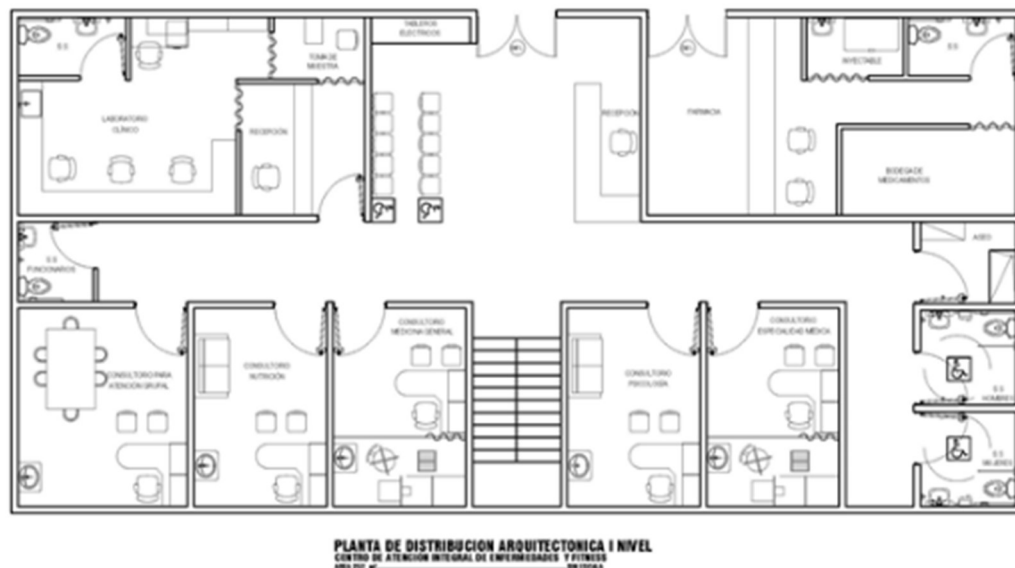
Planta de distribución arquitectónica del I nivel del edificio a remodelar.
